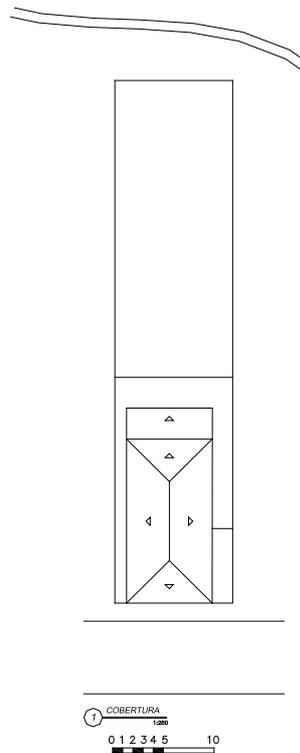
Planta situação / diagrama de telhado - Casa Nadir Dutra Lopes
